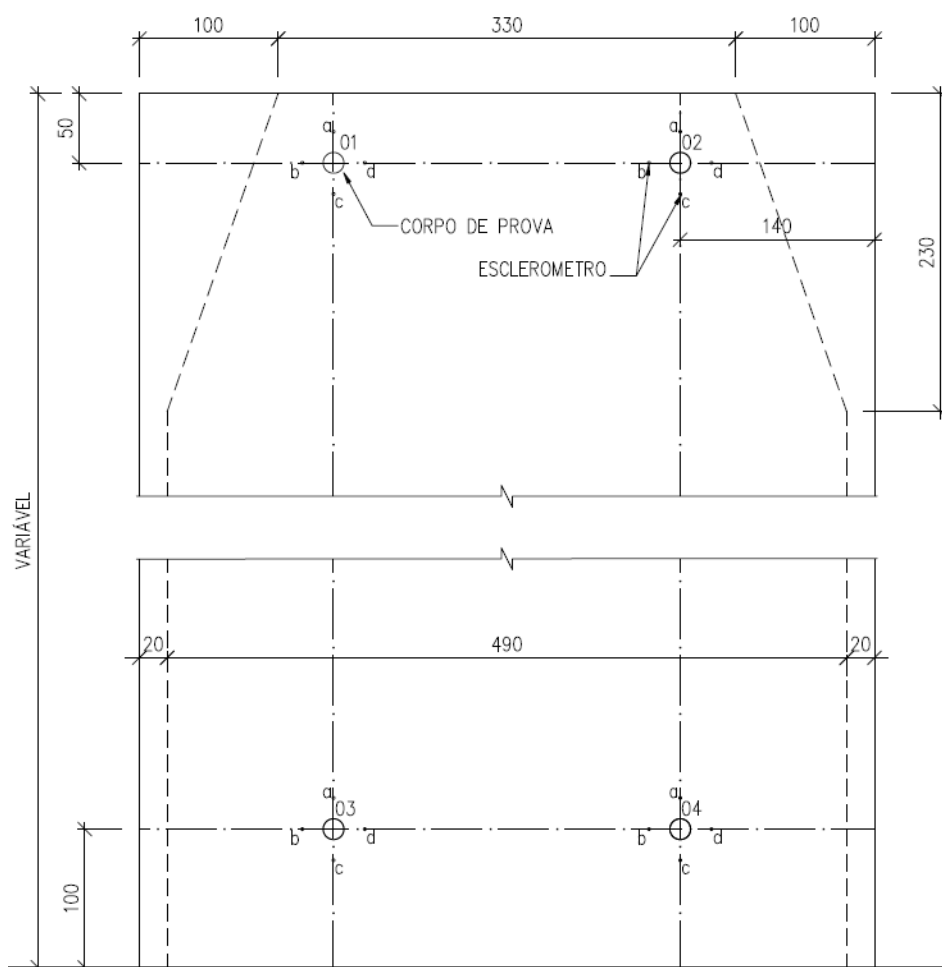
extração/esclerometria para pilares de seção caixão (incluindo pilares de transição) – Face Leste
